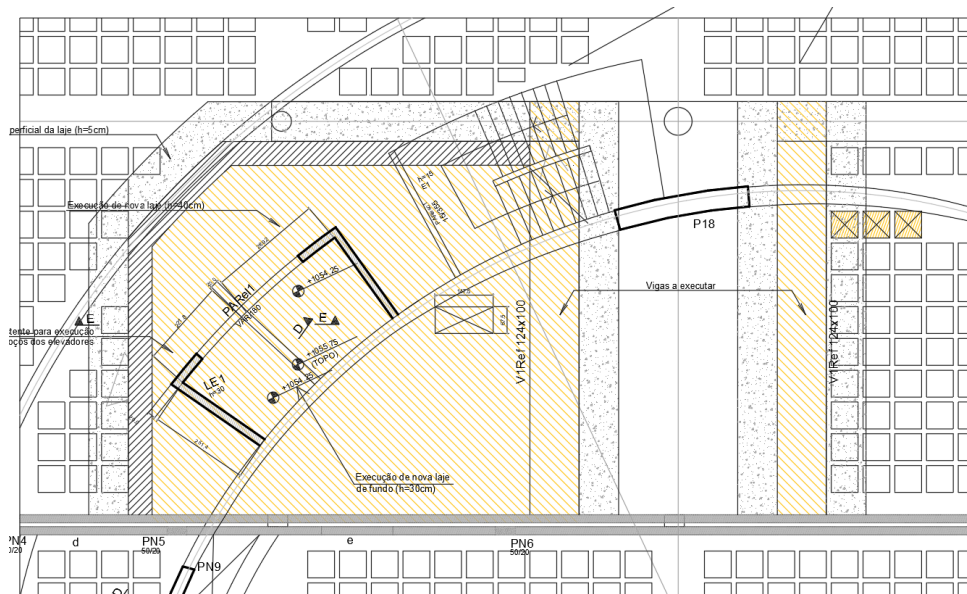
Exemplificação das zonas a demolir para inserção dos poços dos elevadores.
